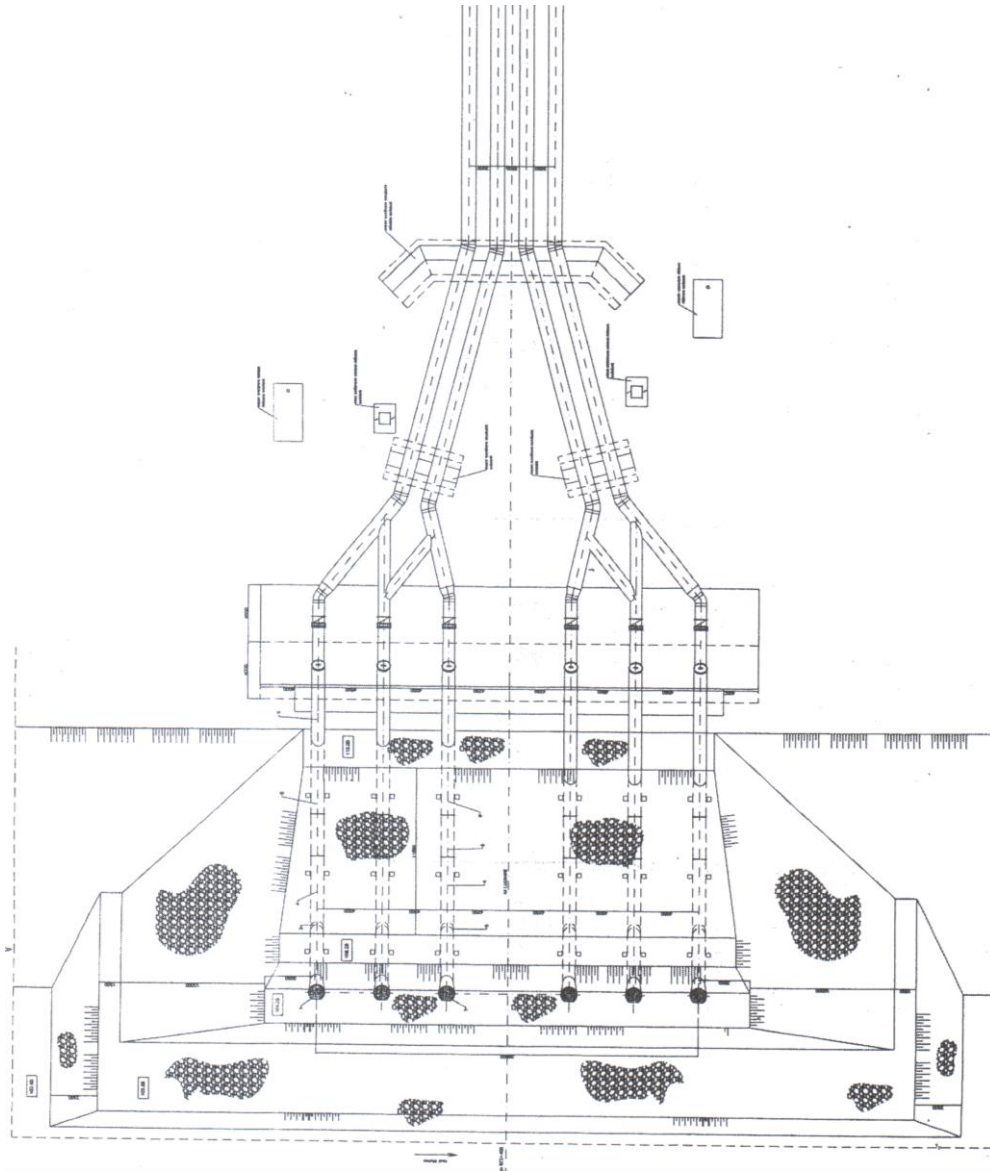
INSTALATII HIDROMECHANICE – AMPLASAREA STATIEI DE POMPARE SPA FANTANELE LA MAL PE RAUL MURES KM 672+400. JUD. ARAD – VEDERE IN PLAN, SECTIUNE (S.P.A.) [103]
